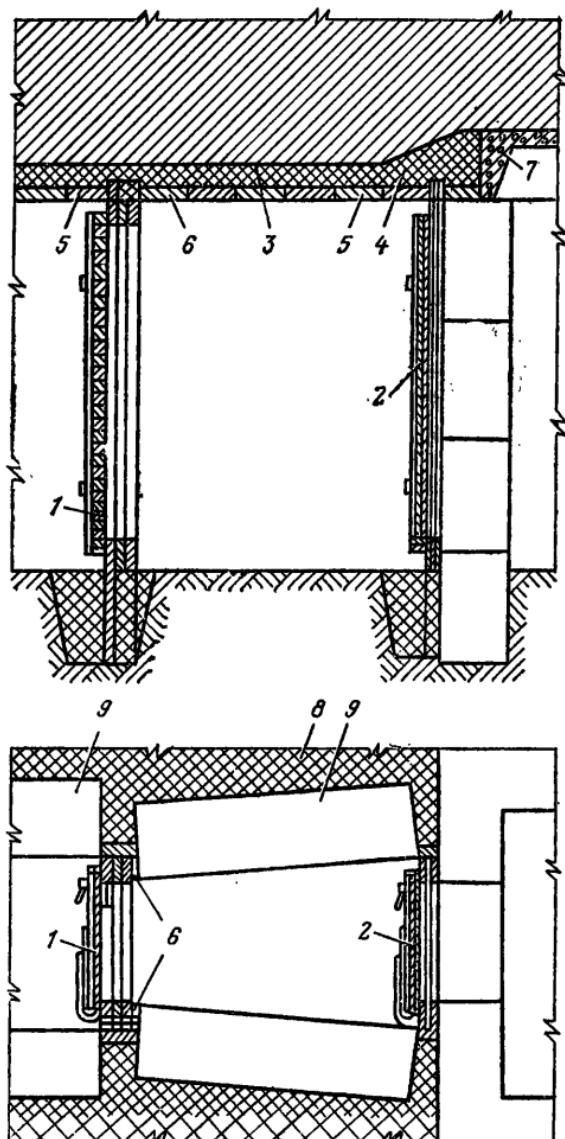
Узлы примыкания дверных блоков во входах к стенам из железобетонных блоков:
